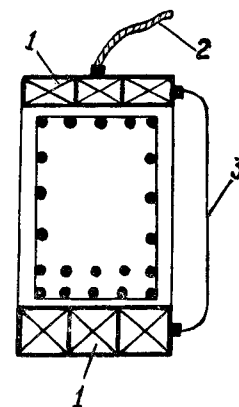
Расчлененное расположение заряда на подрываемом железобетонном элементе:
